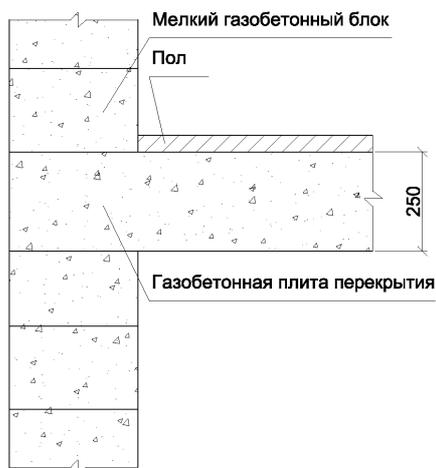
Опираие газобетонной плиты перекрытия на несущую наружную стену из мелких блоков (опирание по всей толщине стены)
